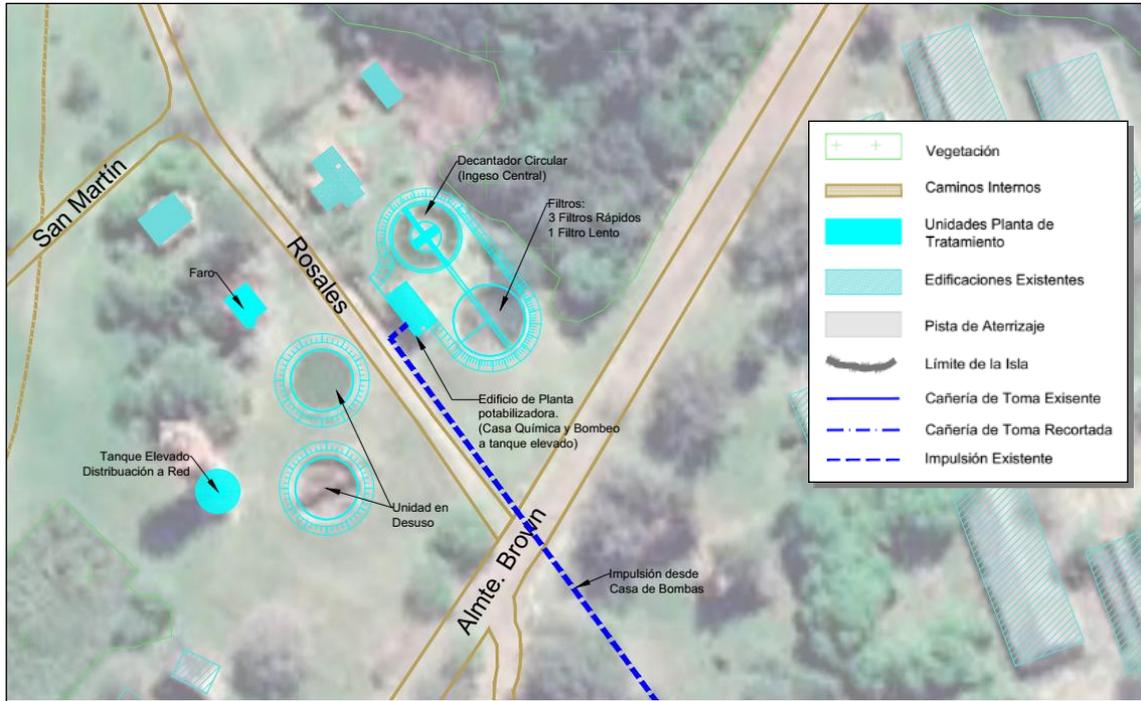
Ubicación general la Planta Potabilizadora, Cisterna y otros componentes.
